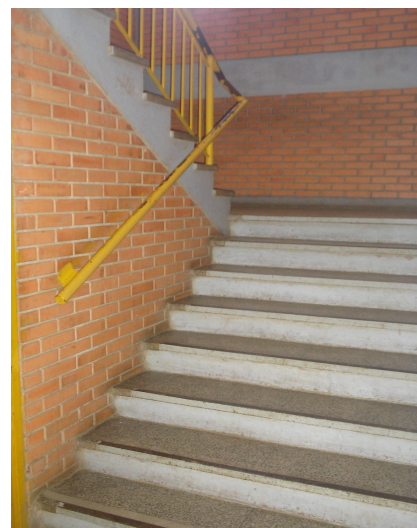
Acesso ao pavimento superior (Fonte: Arquivo pessoal).
